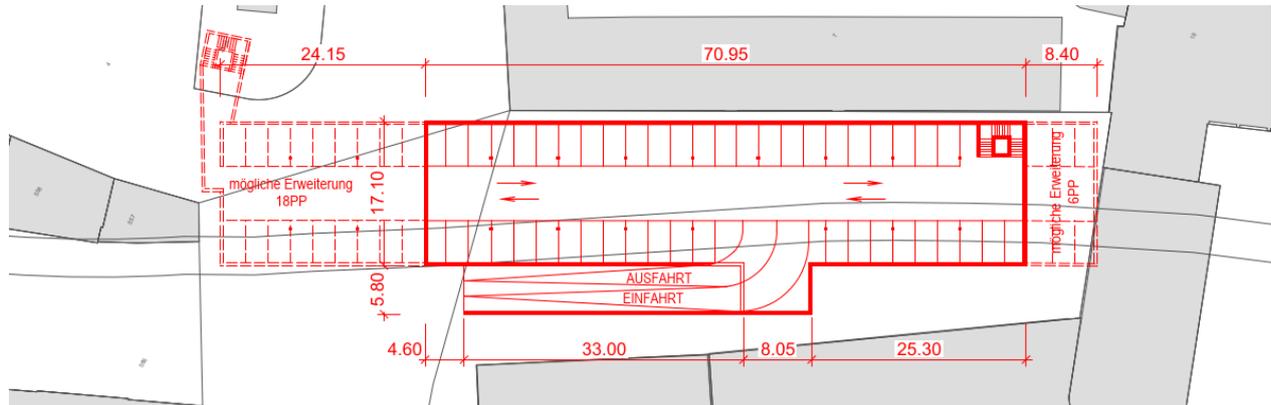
Ausschnitt Situation Variante Obergrund 1.2 Grundriss Parkgeschoss
